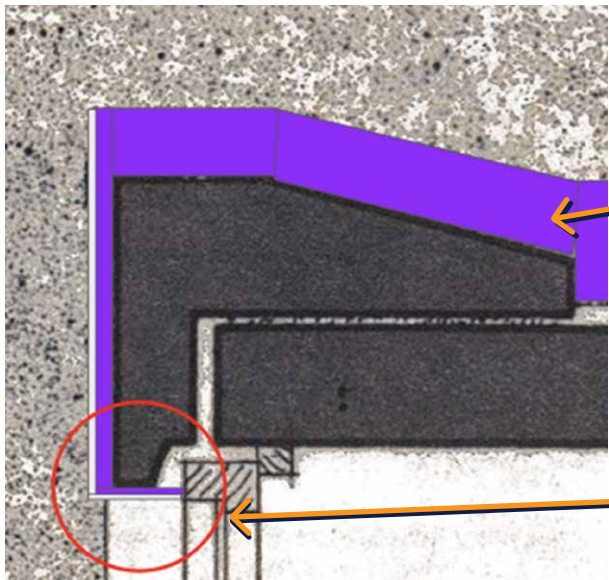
koudebruggen: de opstaande betonnen rand van het dak inpakken, zie onder
